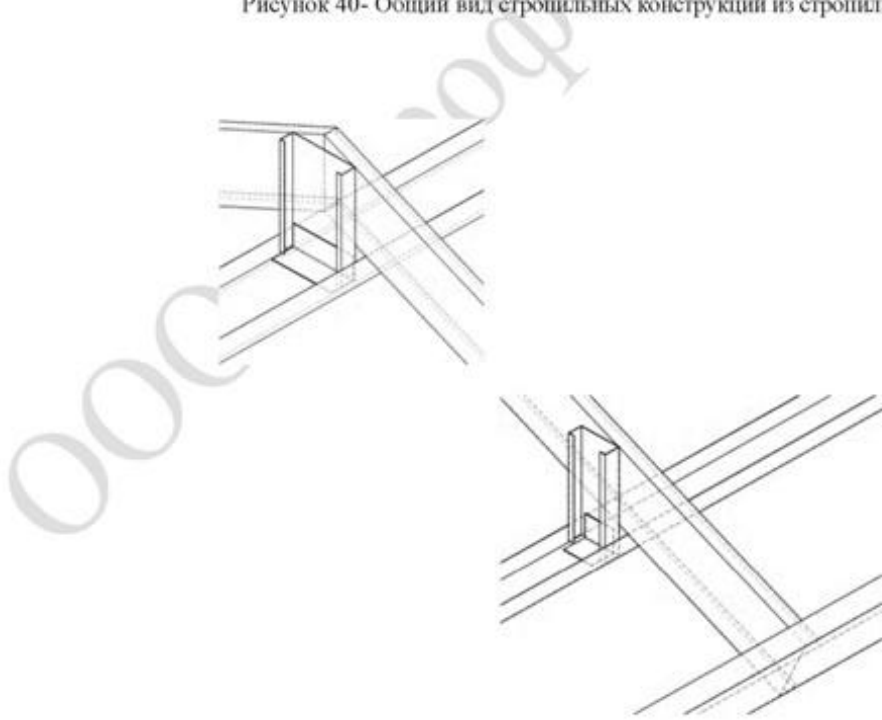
Конструктивное решение узлов опирания стропильной балки
